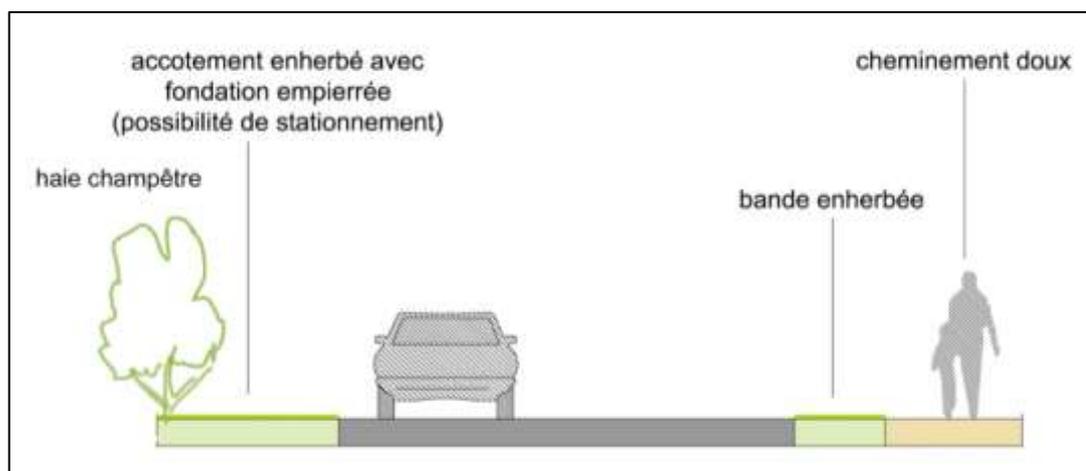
Exemple de profil en travers envisageable pour la voie à créer
